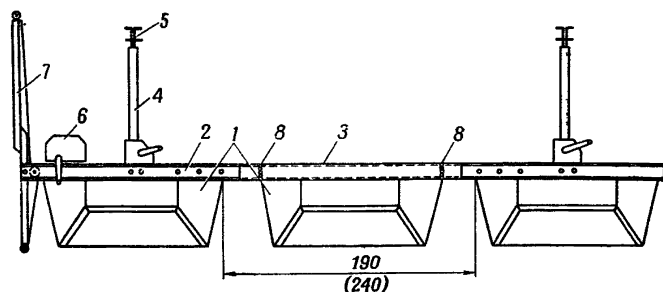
Паром с домкратами на трех лодках ДЛ-10:
